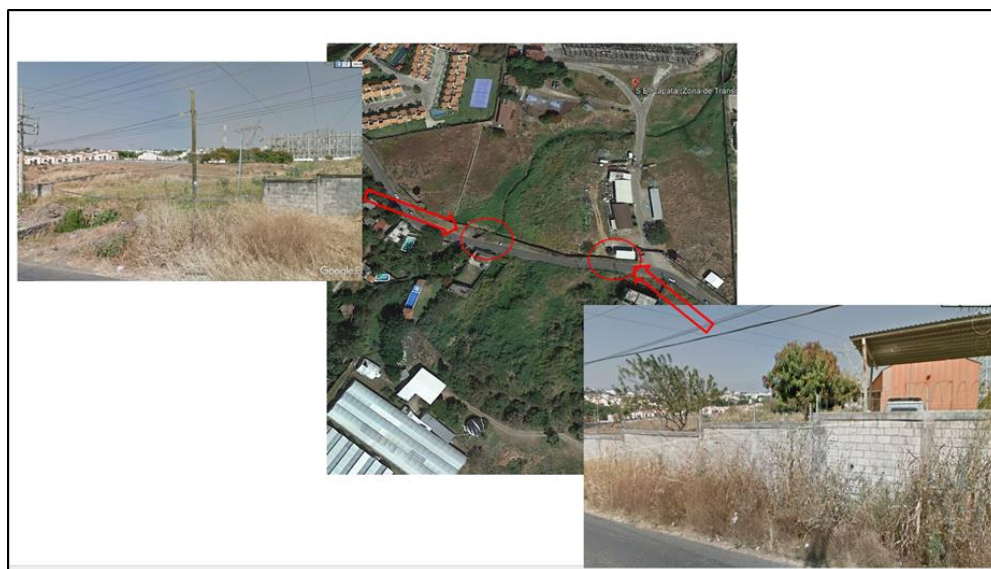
Vista de la reconstrucción de la barda perimetral (Google Earth, 2017)
